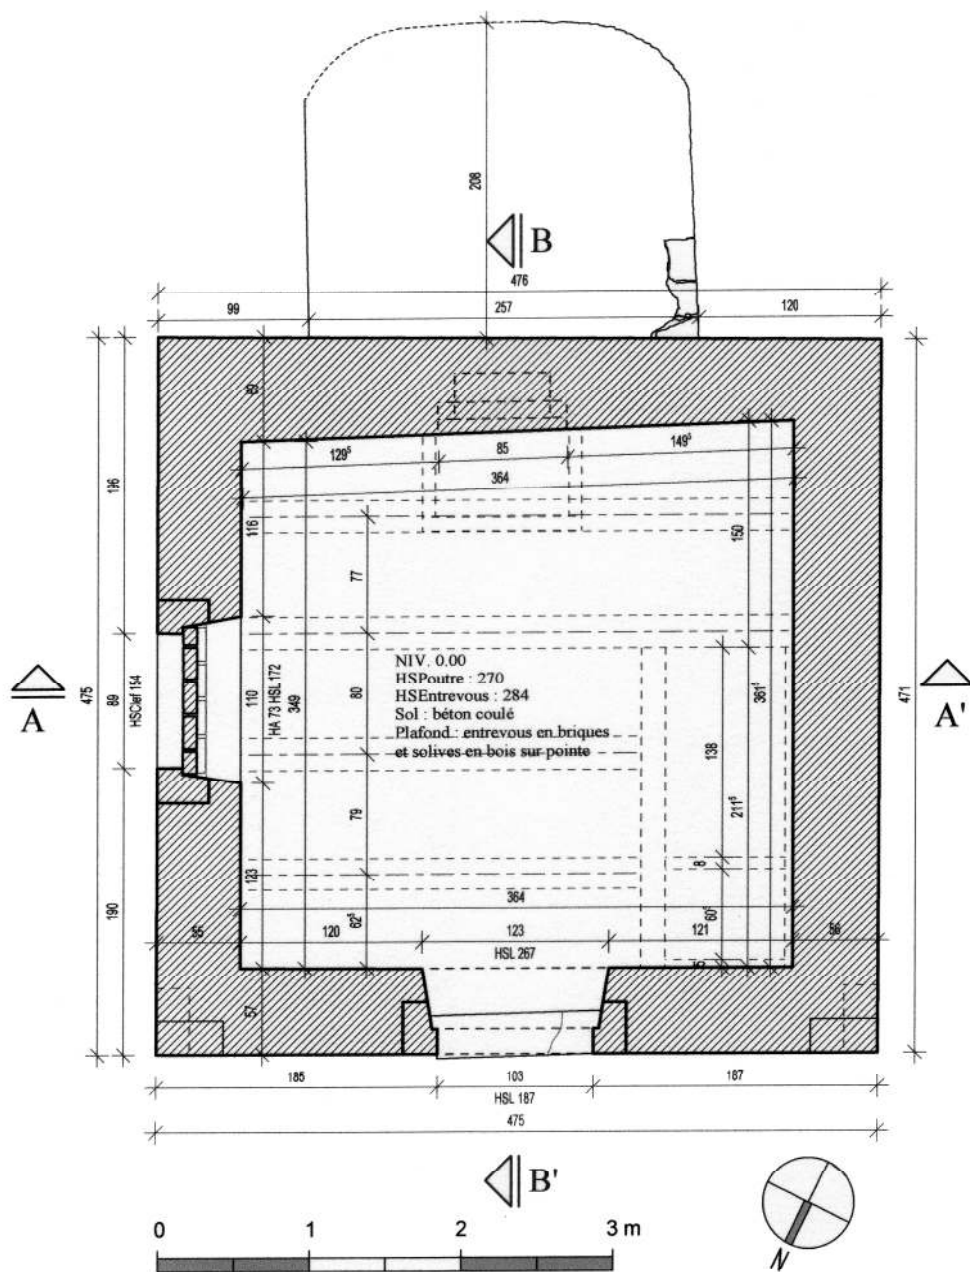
Pavillon et four. Vue en plan rez-de-chaussée. Ech. 1/50^e. Situation existante. IG 2003.
